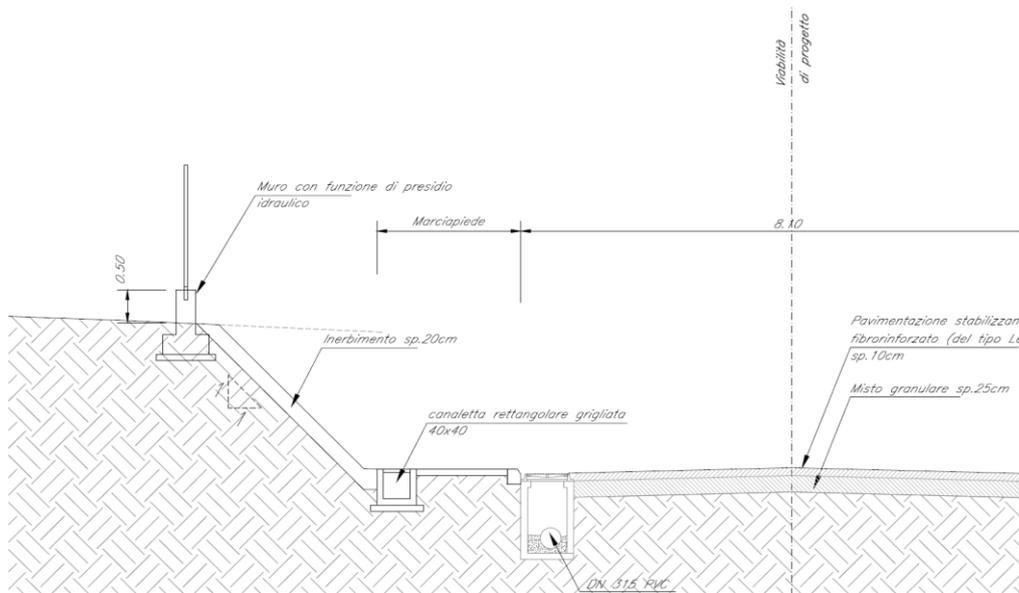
Dettaglio sezione in trincea (piazzale viabilità NV01)
